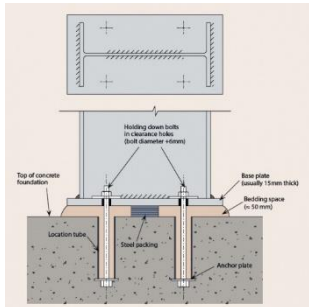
L'un des mode d'assemblage entre semelle en béton arme et poteau en métal par boulonnage
